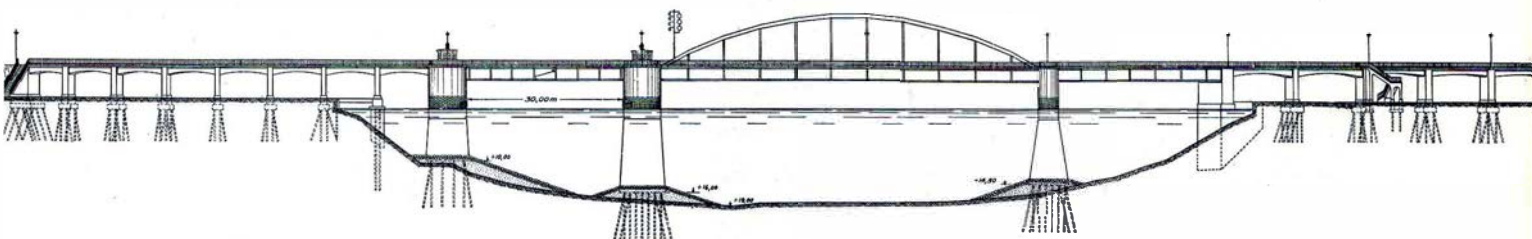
Alssundbroen. Hovedbroen har simpelt understøttede Pladejernsdragere, i Midterfaget (74,8 m Spændvidde) armeret med Stangbuer. Klappfaget er dobbeltfløjet. Tilslutningsfag af Jernbeton (Rammekonstruktion).
